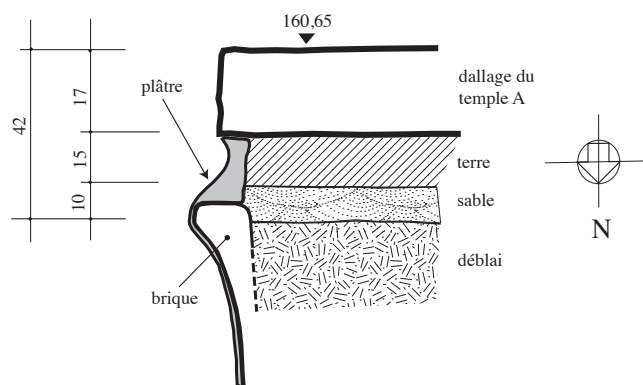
(Dessin : Michel AZIM) : coupe sur la paroi du silo Si4.
